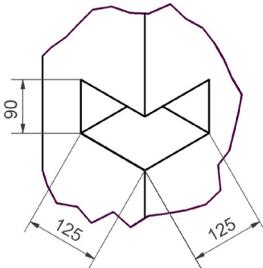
Ankeraussparung für Ausklapp- und separate Maueranker (Einnörtelung Mauerwerk- und Betonwand)
